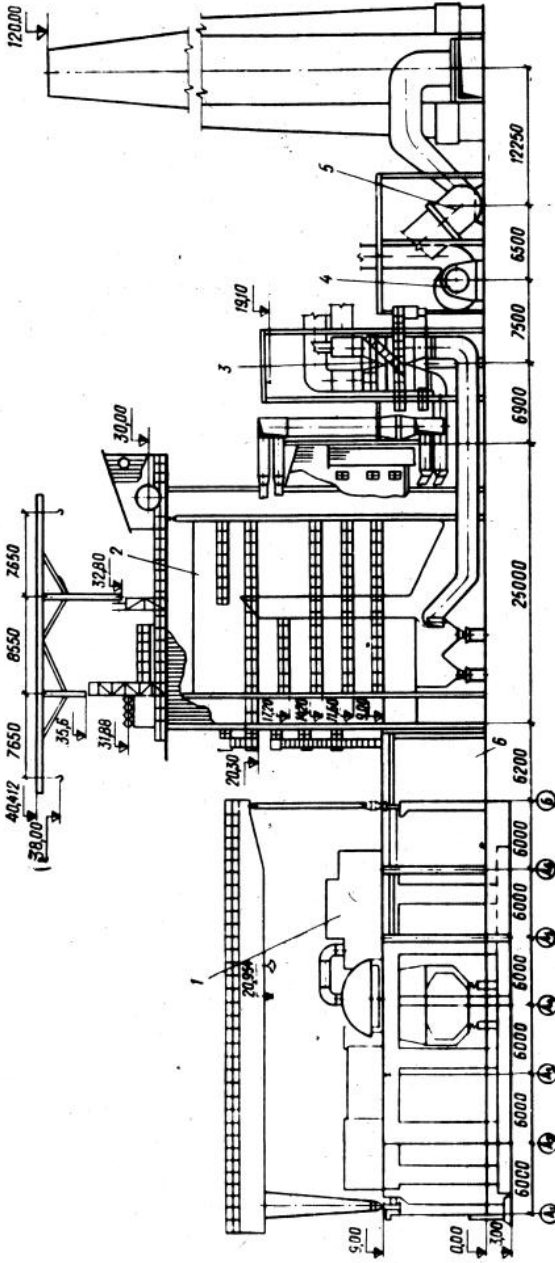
Поперечный разрез главного корпуса газомазутной ГРЭС с открытой компоновкой.
